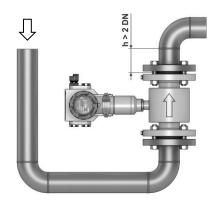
Монтаж расходомера в трубопровод с нисходящим потоком
